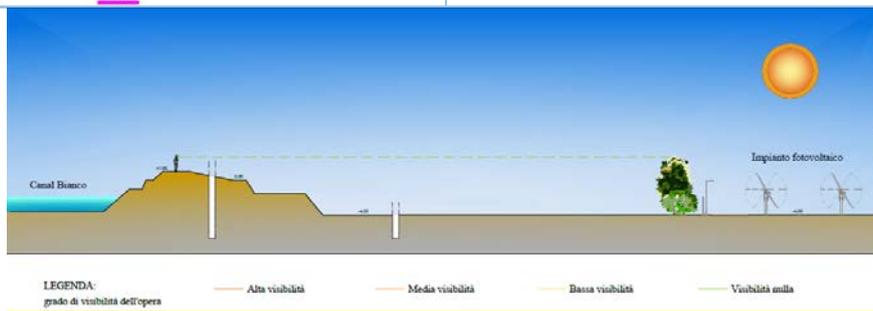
Sezione di intervistibilità dal punto di vista chiave n. 2 dal lato sud, dall'argine sx del Canalbianco
